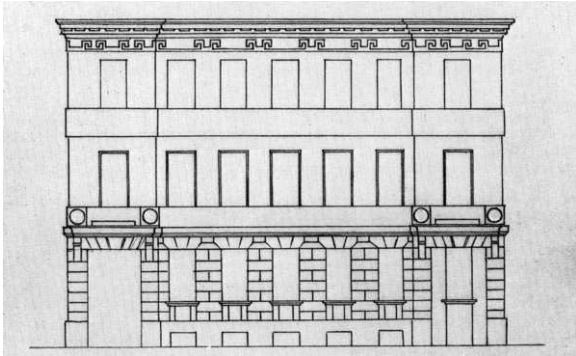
| Friedrich Gilly: Stadthaus Jägerstraße 14, Berlin (1792-1794).
